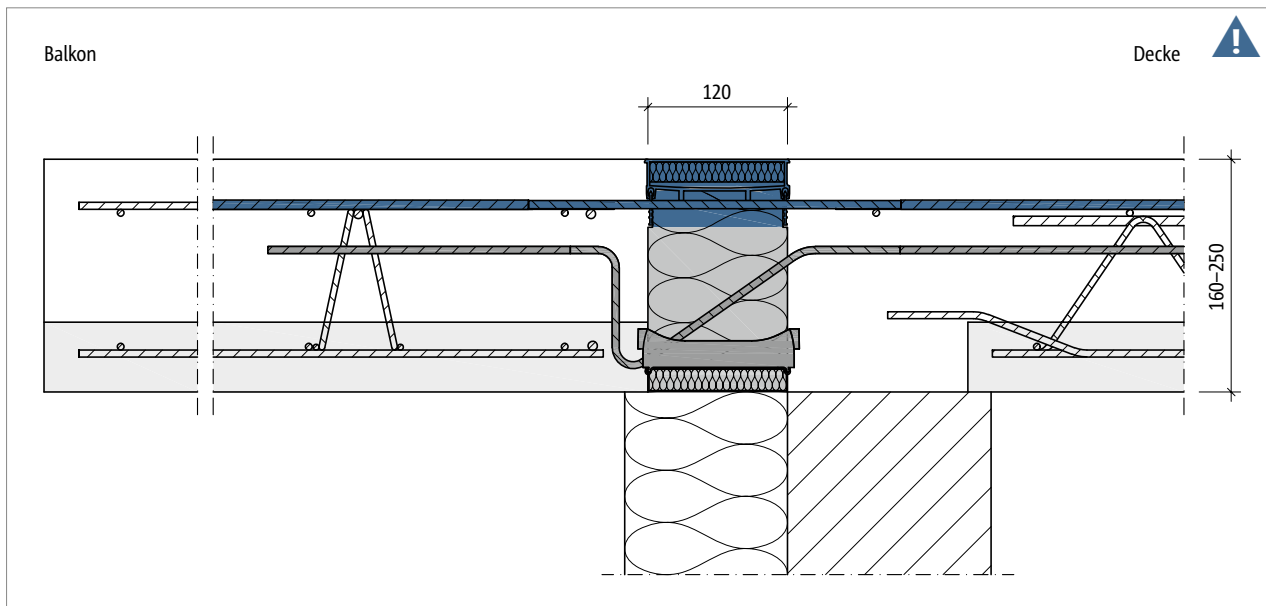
Schöck Isokorb® XT Typ KL-F: Oberteil zur Zugkraftübertragung erforderlich
